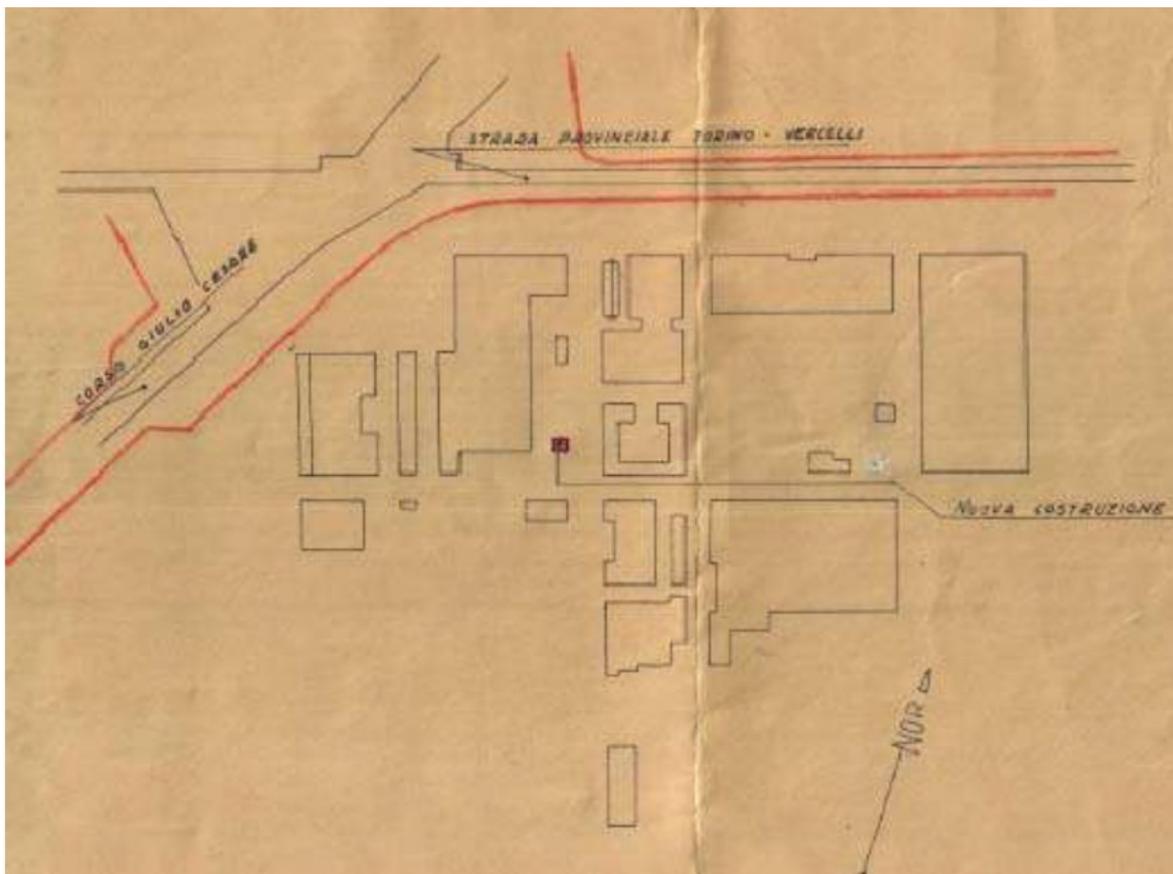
Planimetria catastale 1941 (Fonte dati Archivio Città di Torino)
